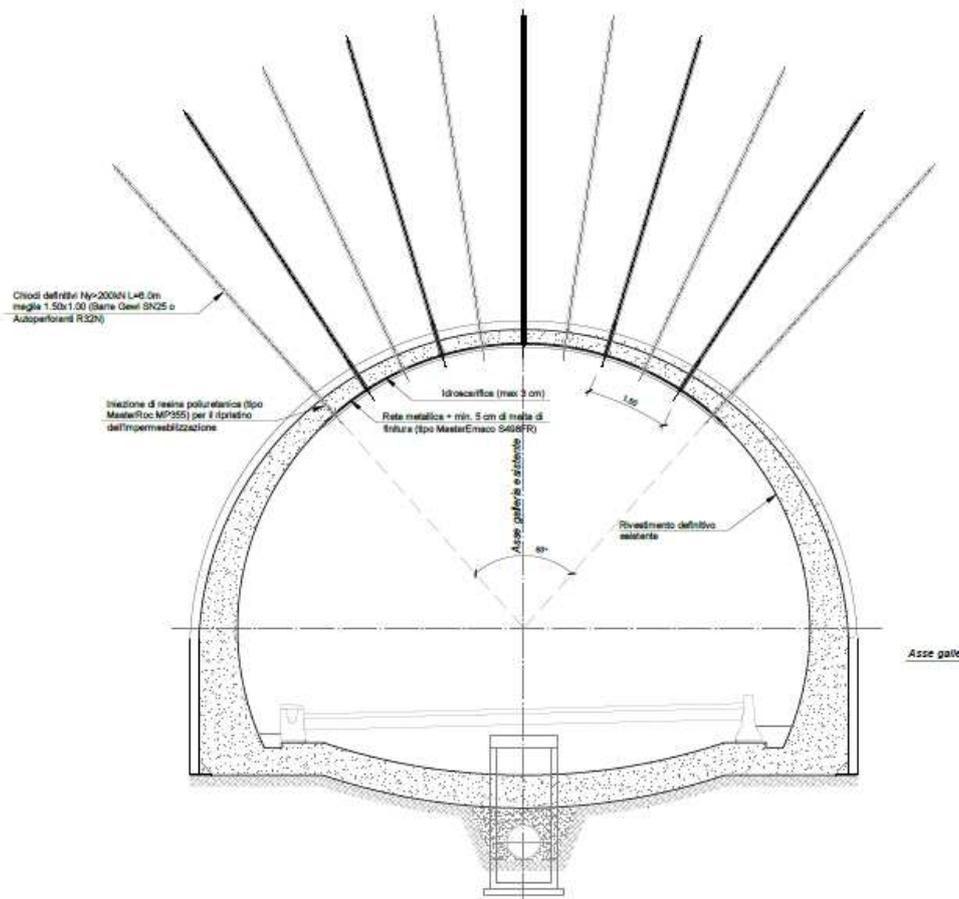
Galleria Guinza – Intervento Tipo B – Sezione corrente
